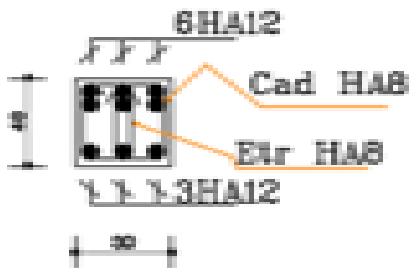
5.1 Schéma de ferrailage des poutres principales
